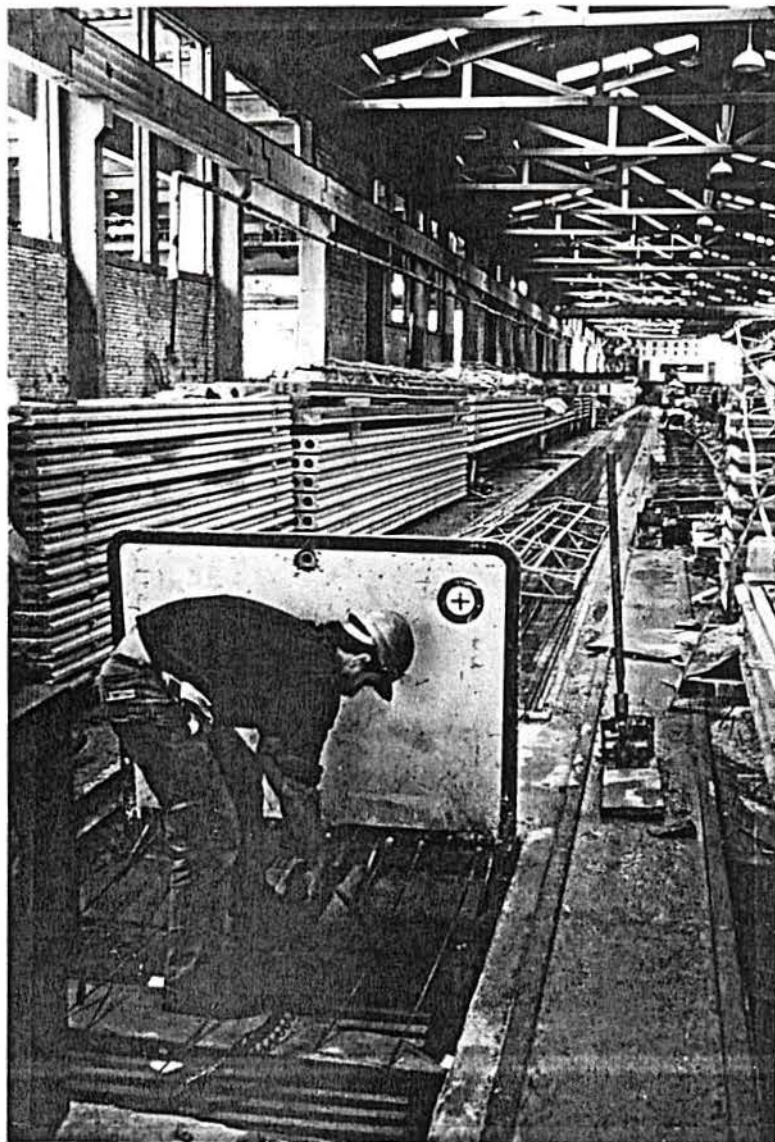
Execução da protensão, cordoalha a cordoalha, com a devida proteção contra acidentes. A armadura é protensionada sobre as pistas
